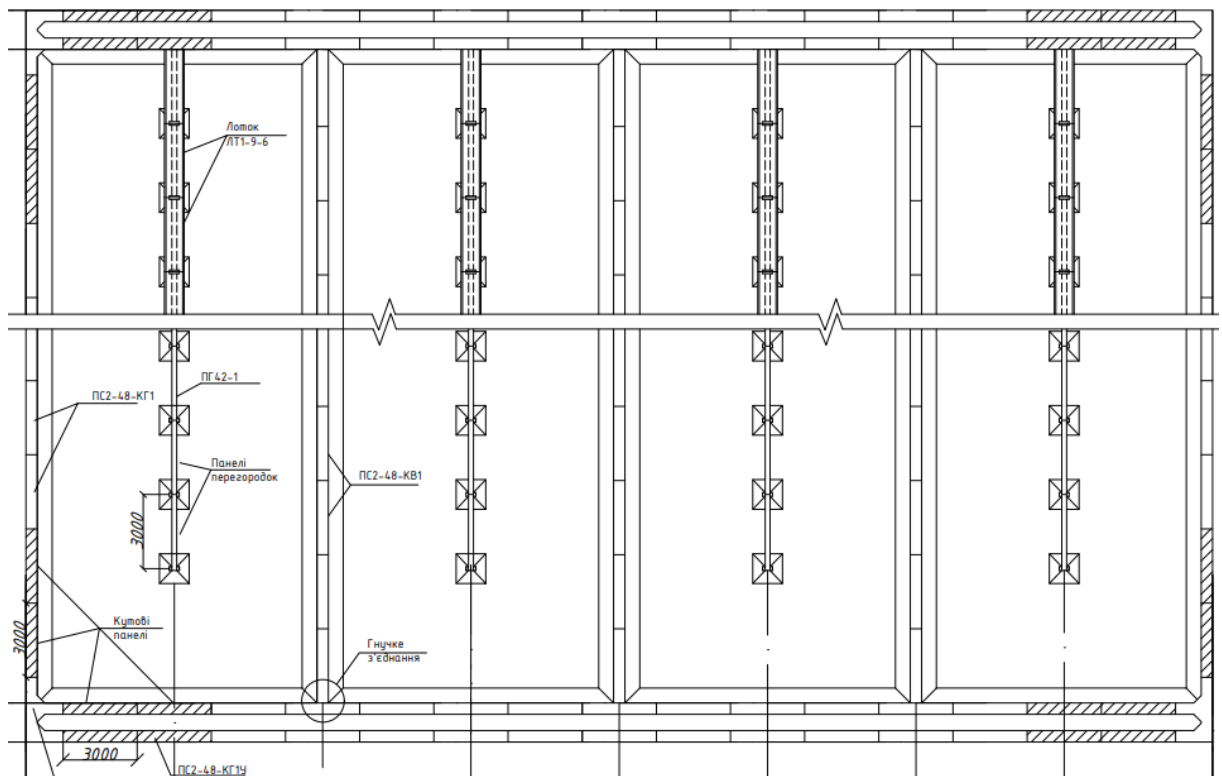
Схематичний план аеротенка з маркуванням конструкцій каркаса
